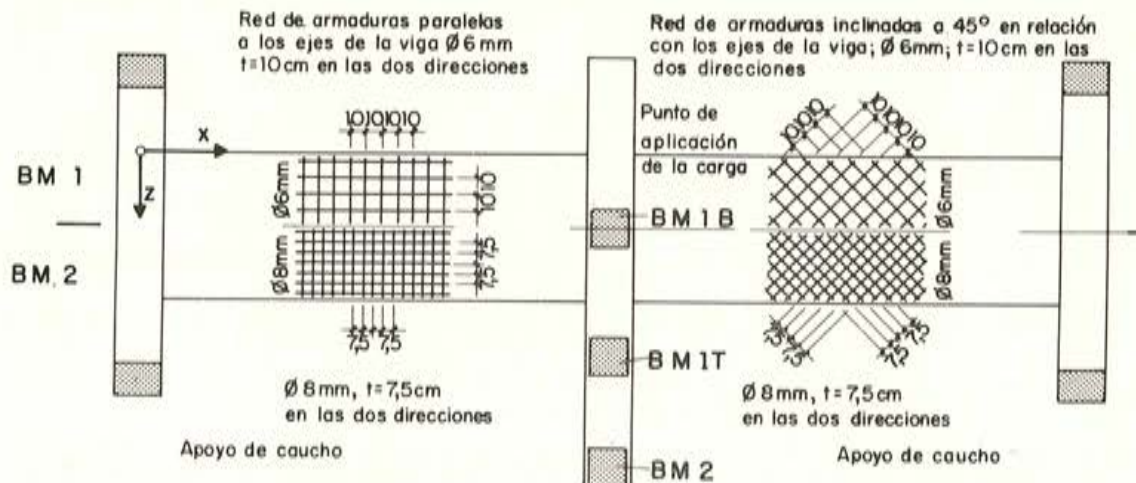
Vigas de ensayo. Disposición de las armaduras ordinarias.
